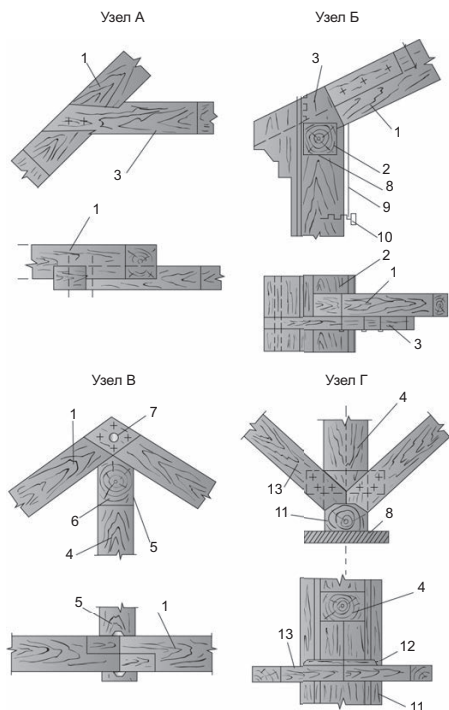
Узлы элементов наслонных стропил: 1 — стропильная балка; 2 — мауэрлат; 3 — затяжка; 4 — стойка; 5 — коньковый брус; 6 — шип; 7 — болт; 8 — гидроизоляция; 9 — проволочная скрутка; 10 — костыль; 11 — лежень; 12 — деревянная накладка; 13 — поперечный подкос
